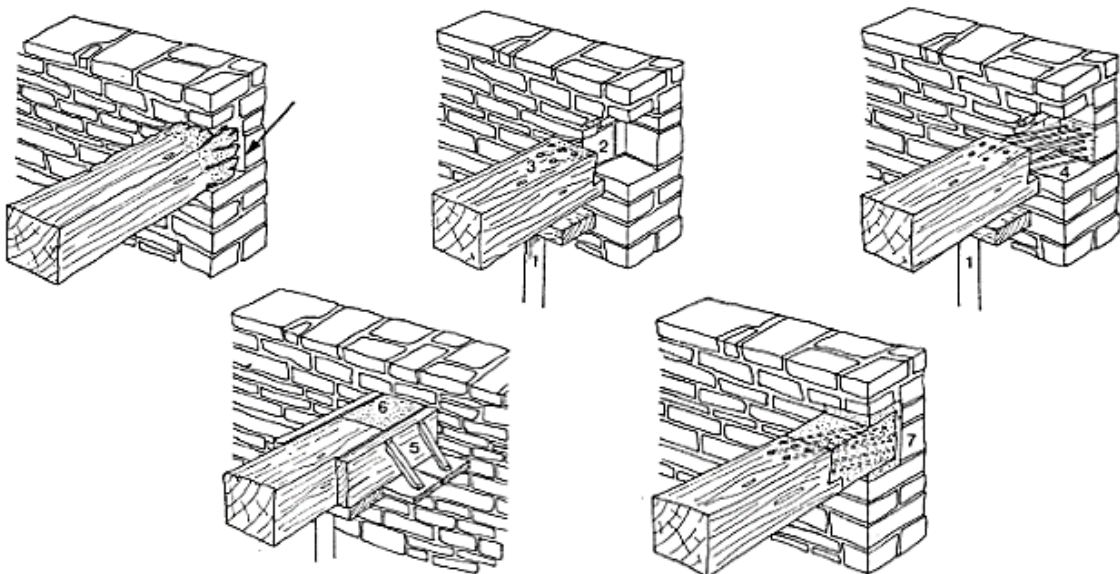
Proceso sistema Beta en encuentro viga-muro.
